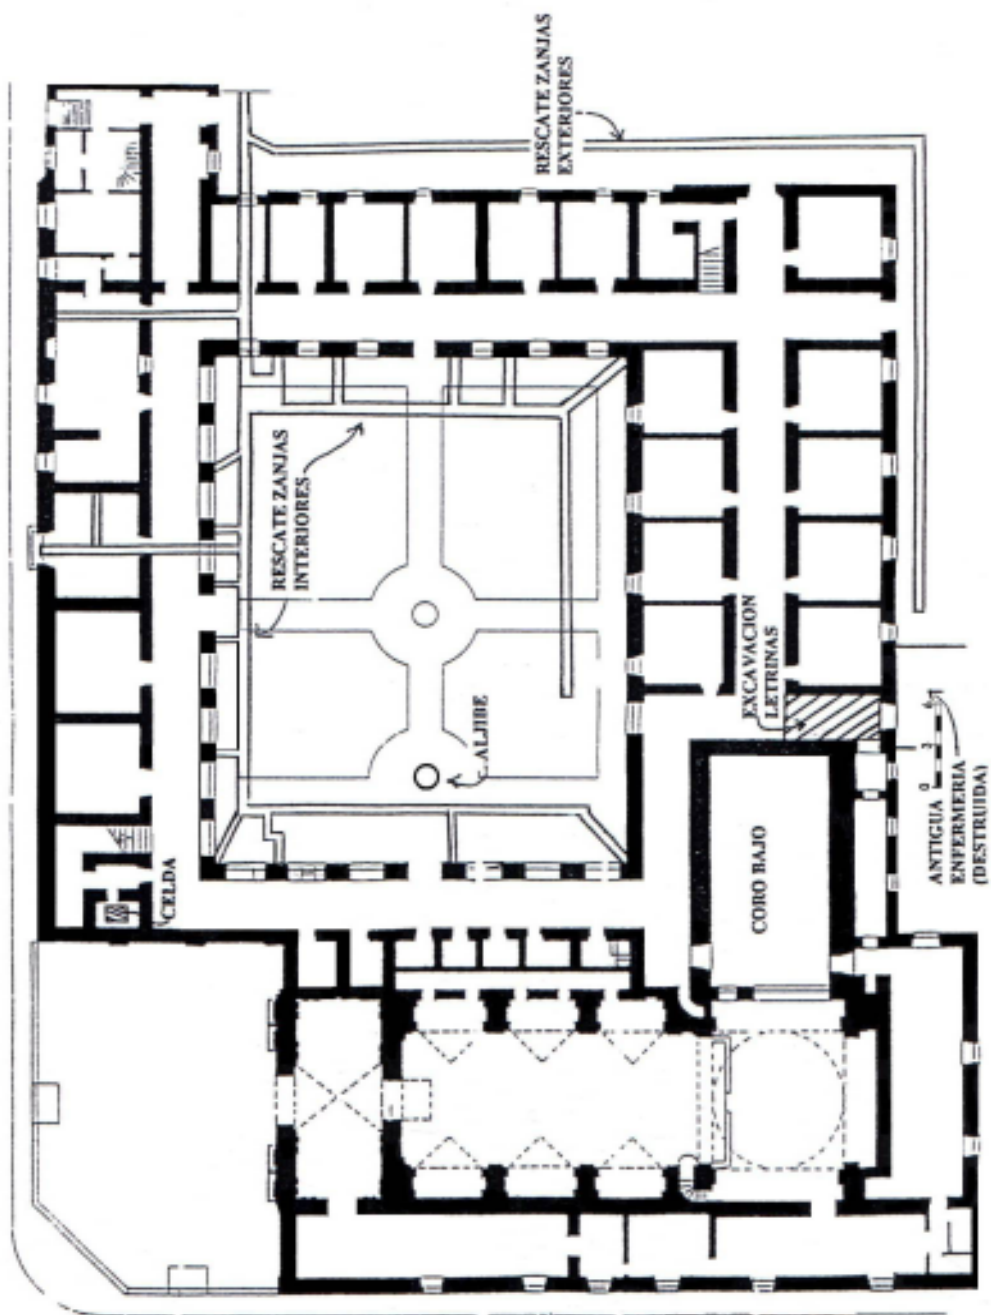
Vista de planta del convento de Santa Catalina de Sena
